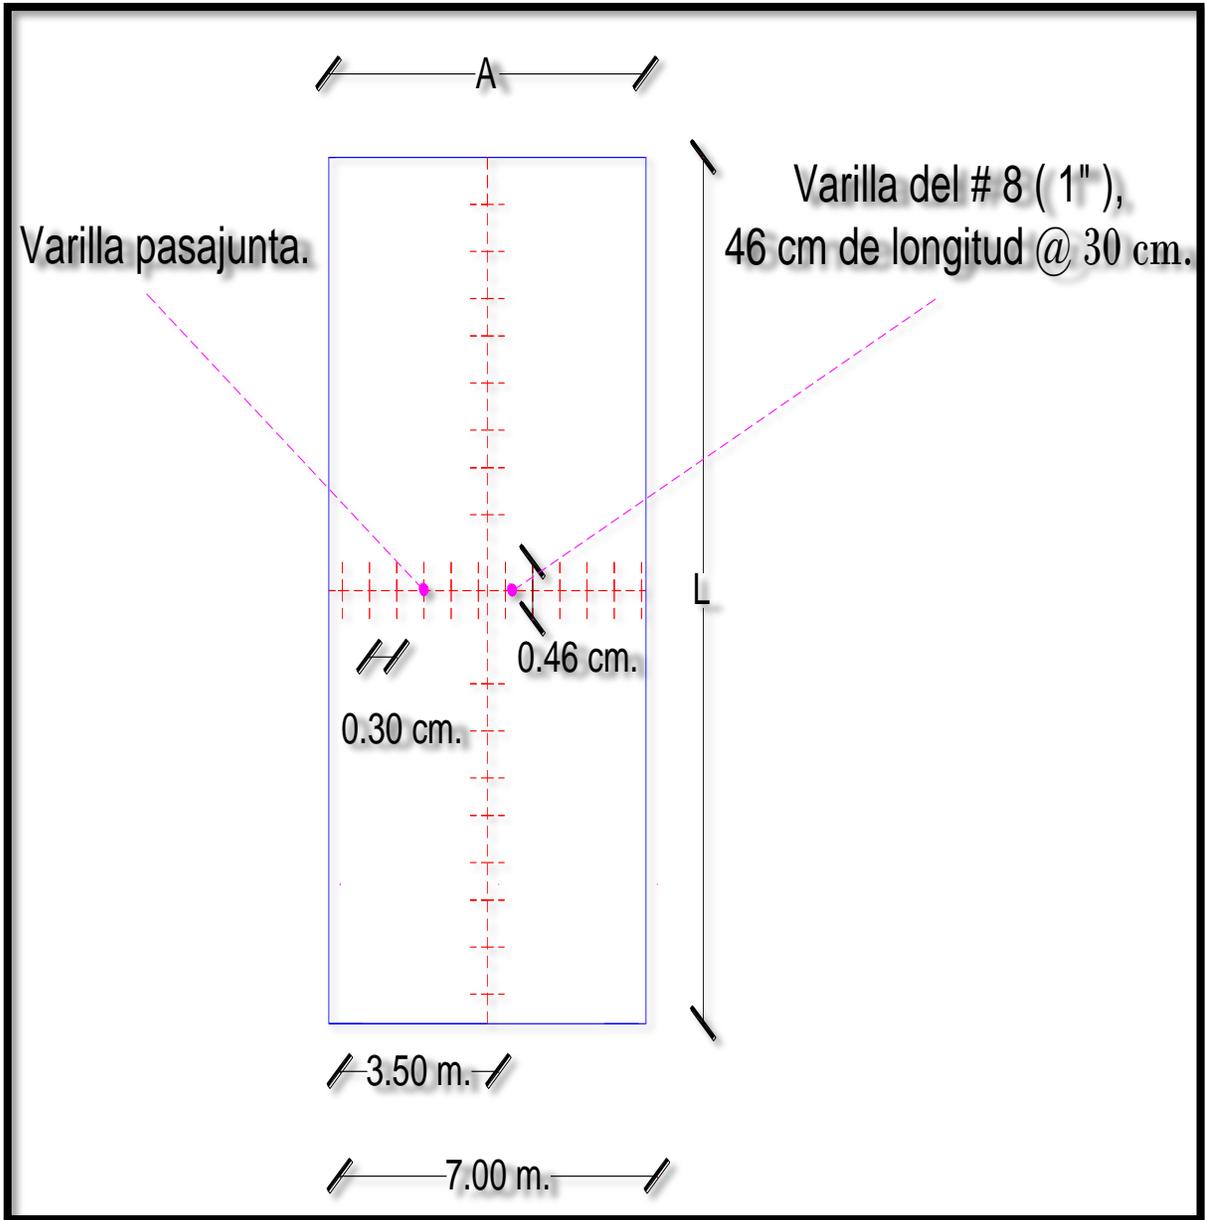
Juntas transversales para diseño de pavimento rígido.
